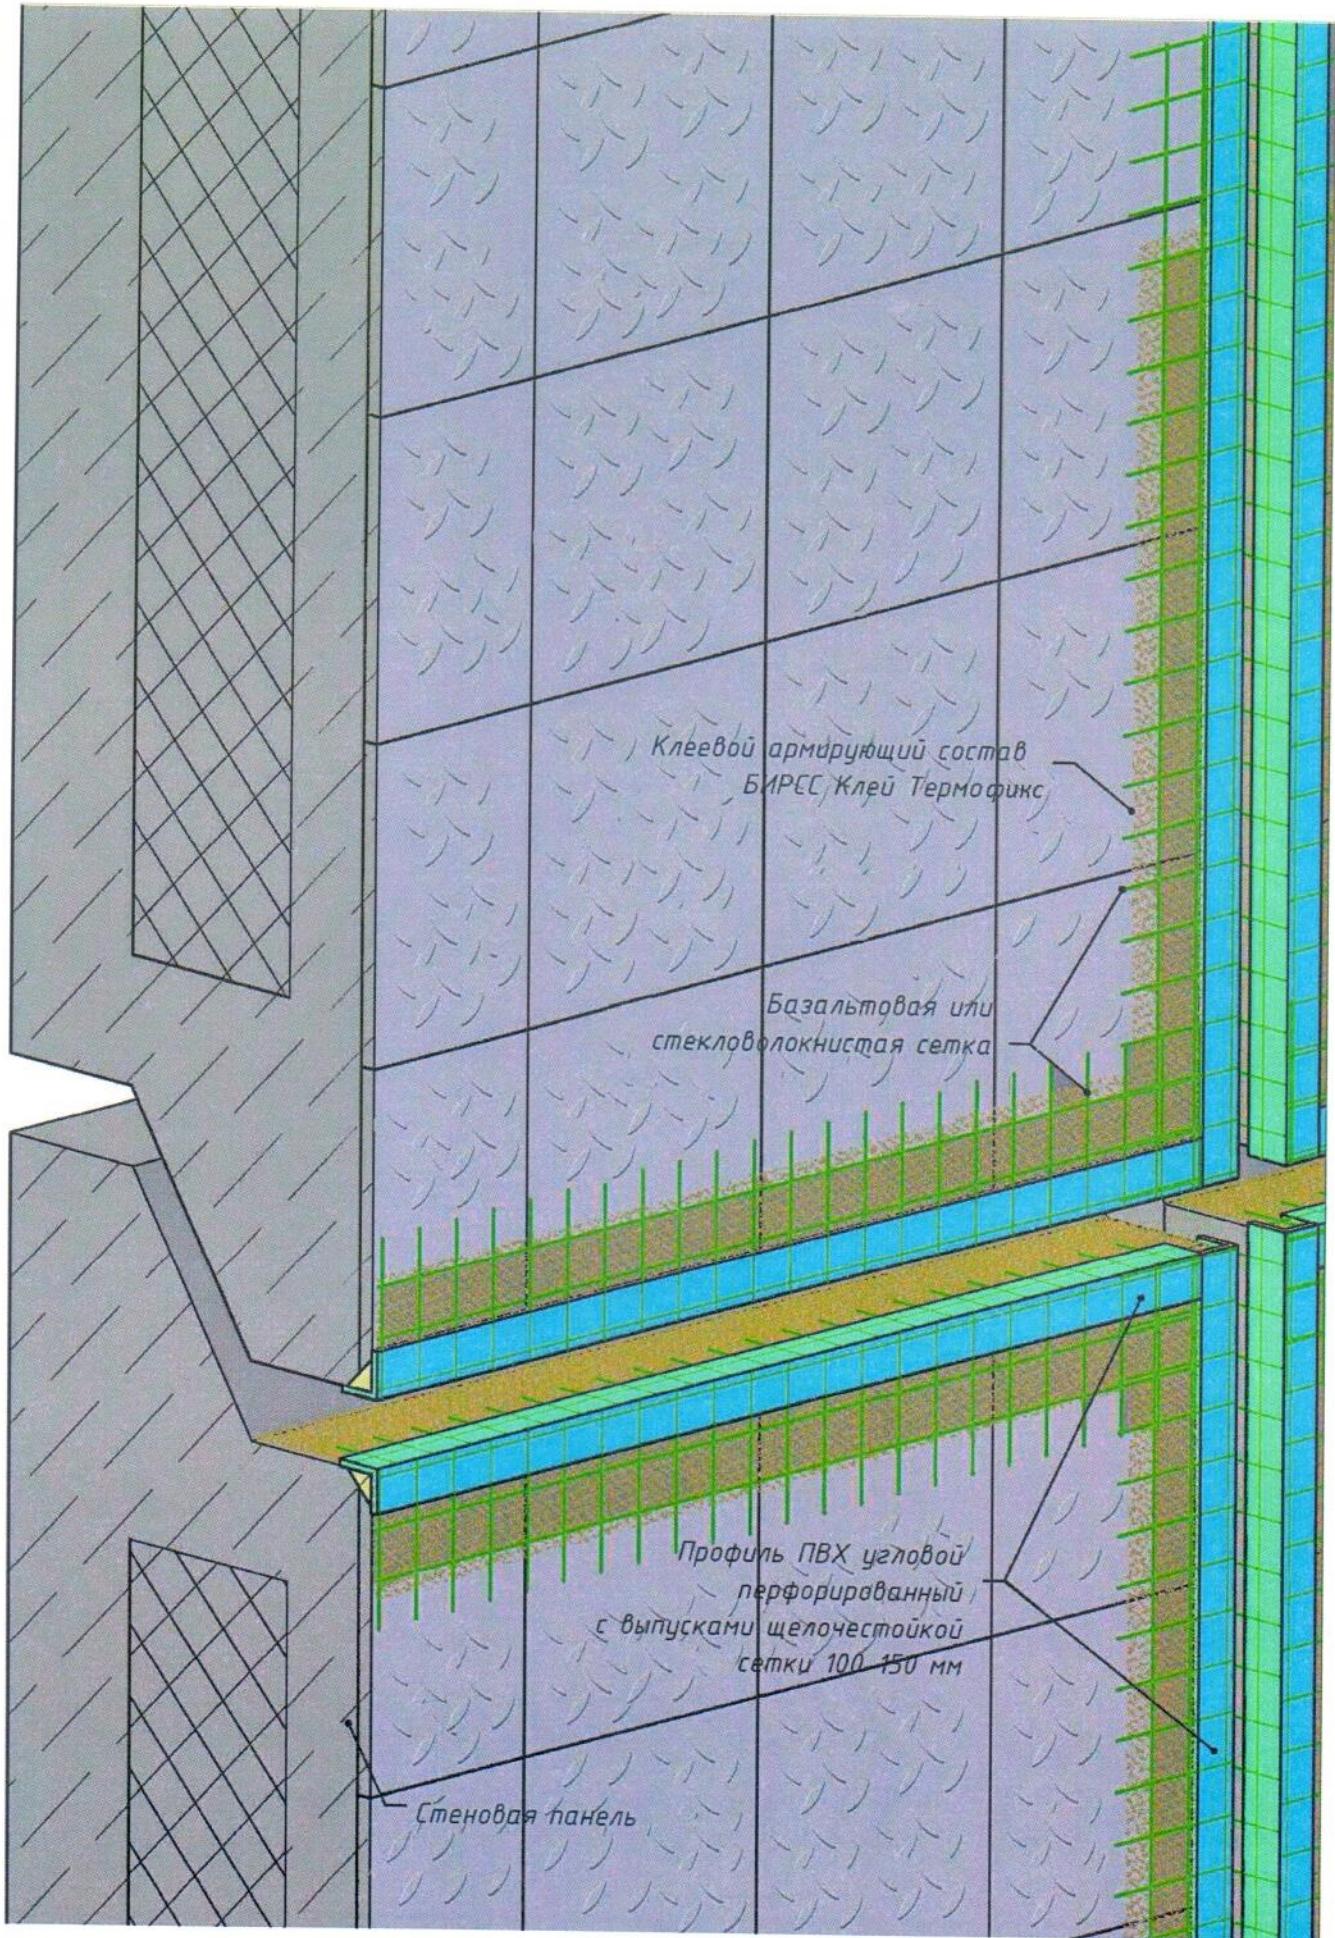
Армирование межпанельного шва угловым профилем из ПВХ с фасадной сеткой
